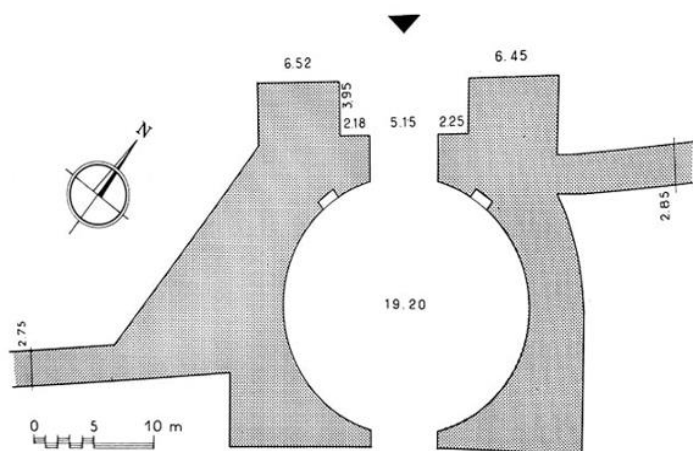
Plan de la porte d'Arcadie, située au Nord-Ouest de Messène : deux tours rectangulaires formaient une première protection précédant la cour en elle-même, d'après ADAM 1982, p.90.
